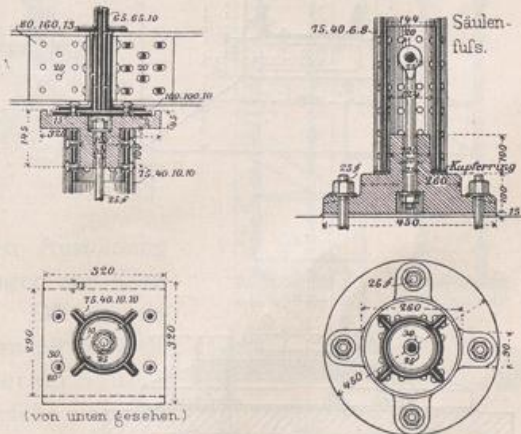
u. 333. Ringförmige schmiedeeiserne Säule mit gußeisernen Kopf- u. Fußstücken.
